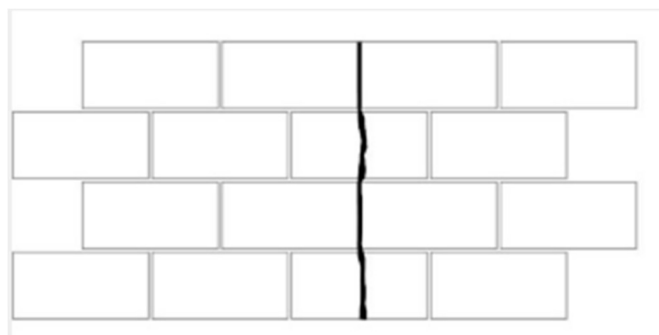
Fissura apresentada na argamassa de assentamento.
